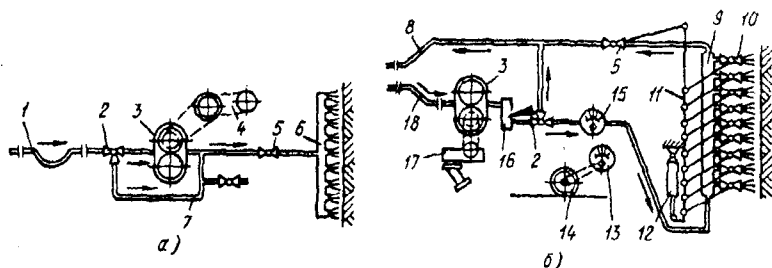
Схема дозировочно-распределительного оборудования для жидких вяжущих и воды: а — с дорожной фрезой ДС-18; б — с фрезой ДС-74.
